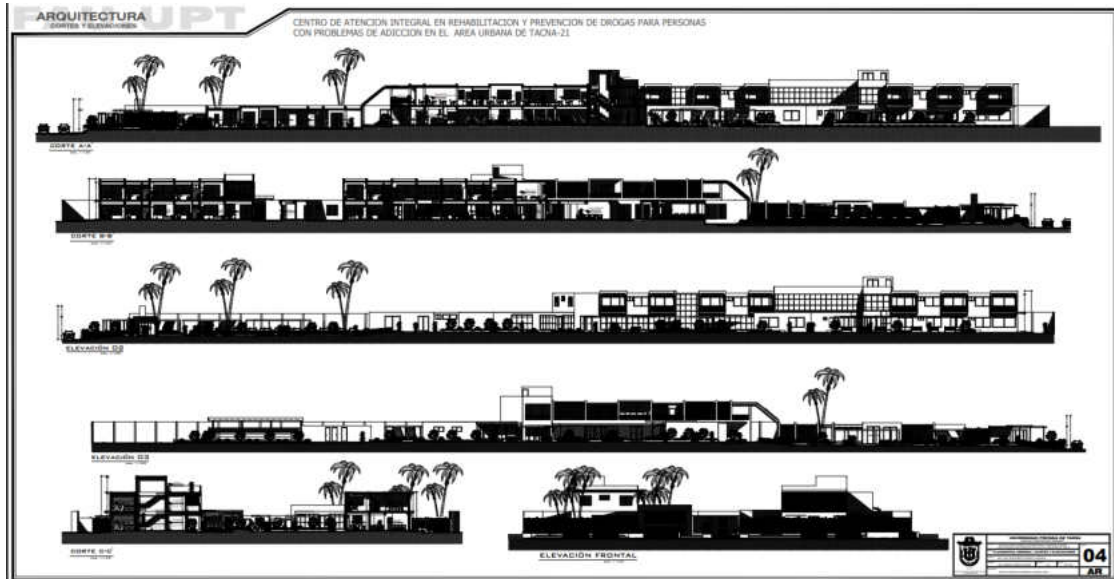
Plano de cortes y elevaciones, fuente elaboración propia
